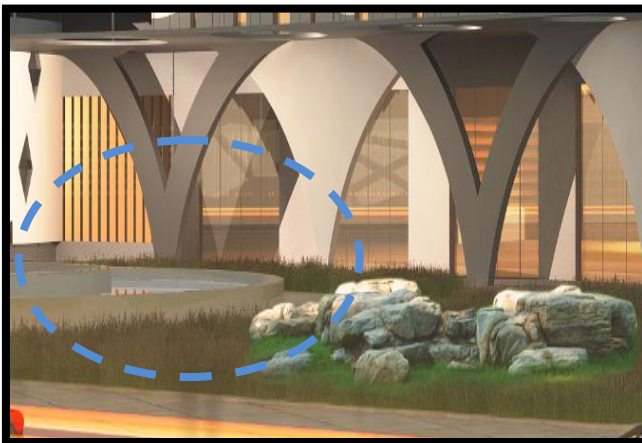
& 15 : Vue sur plan d'eau de côté Ouest du projet. Source : Auteur.
